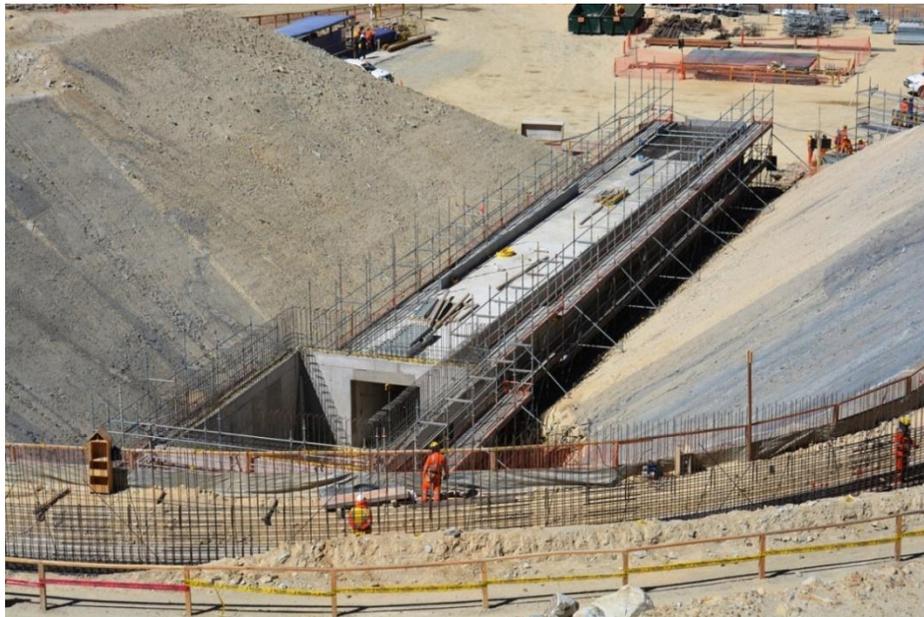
Vaciado de zapatas de los muros perimetrales del espesador en plataforma superior.
